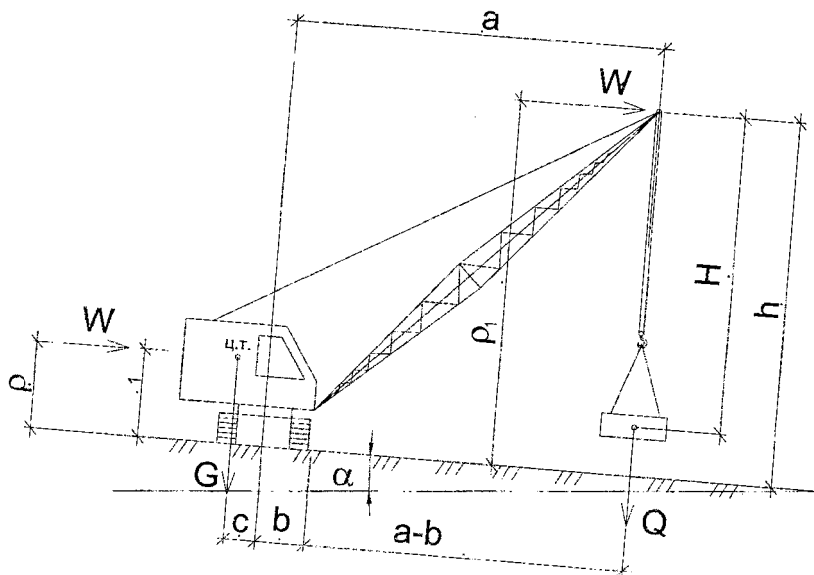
Расчётная схема грузовой устойчивости самоходного крана
